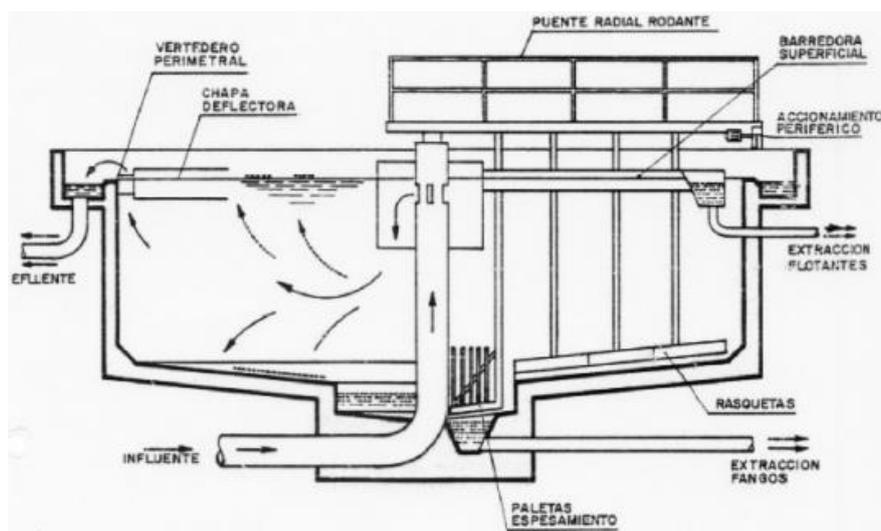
Decantador circular. Fuente: (Water action plan, 2019)
